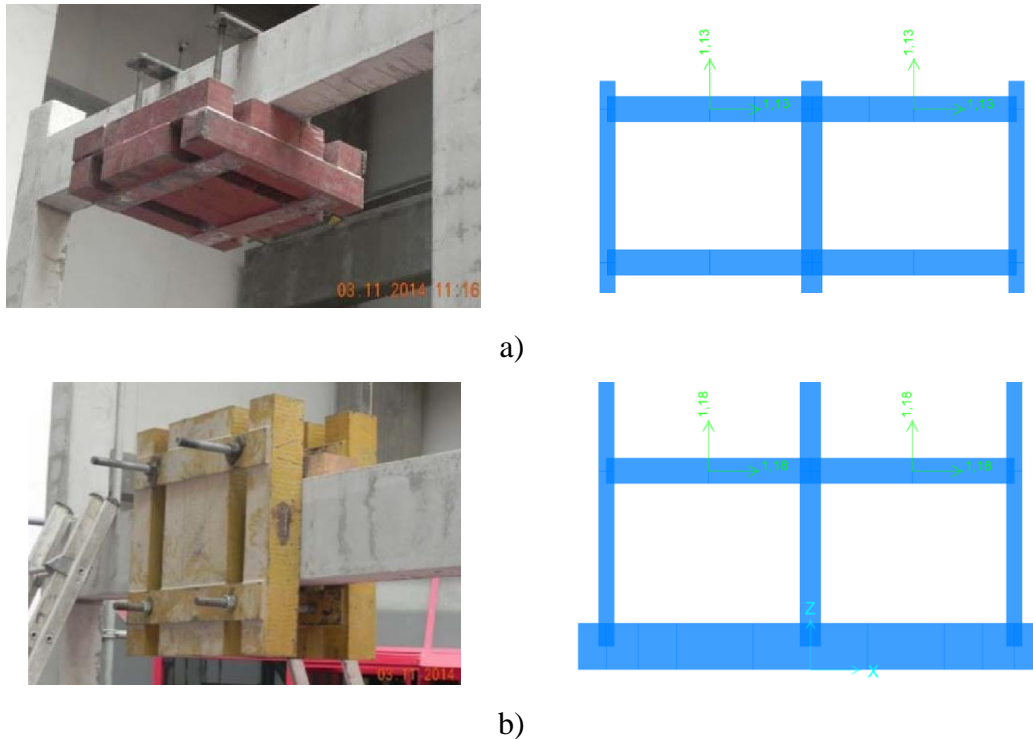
Pormenorização da viga de fundação; a) Alçado transversal do pórtico; b) Alçado transversal do pórtico no modelo numérico do SAP2000.
